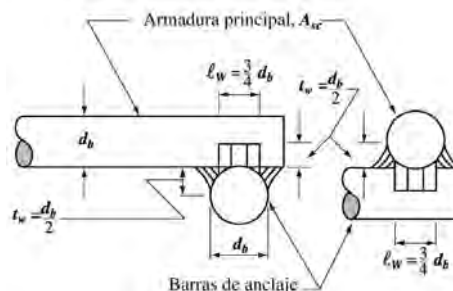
Detalle de soldadura empleada en los ensayos de la referencia C.11.56
